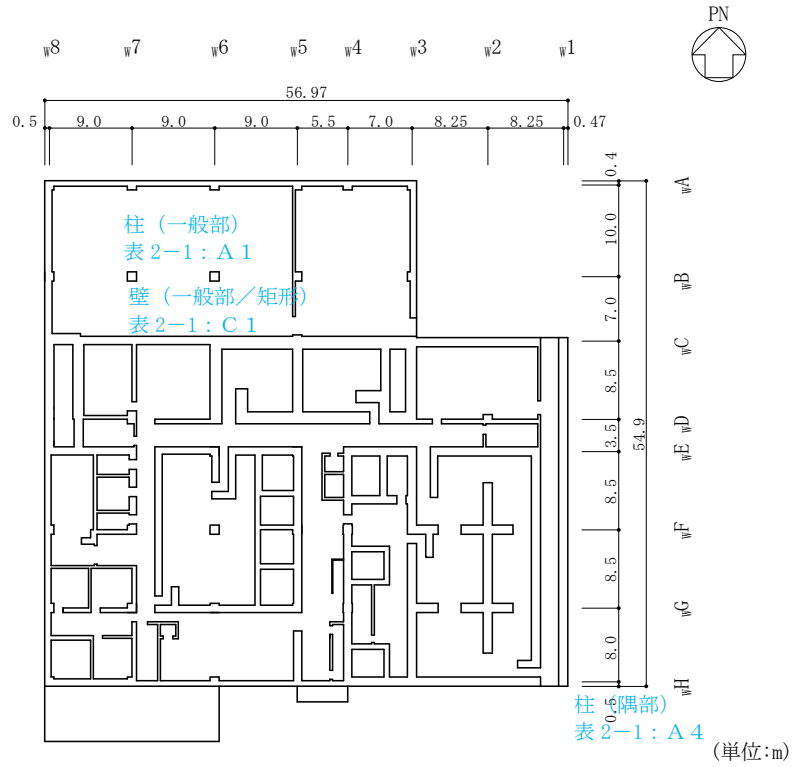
(5) 廃棄物処理建物の概略平面図 (EL 22.1m)
